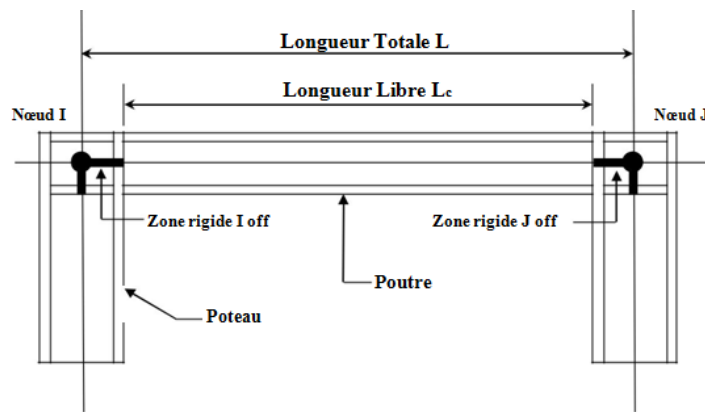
Attribution des Rigid end Offests aux bouts des éléments poutres et poteaux [27].
